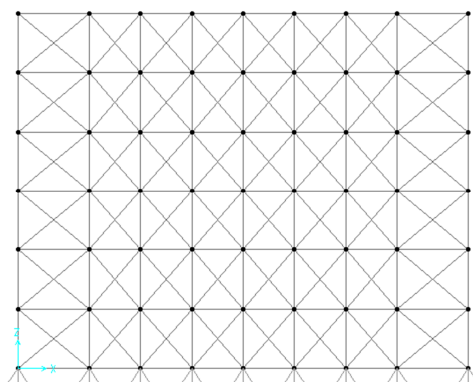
Contraventamento de Plano Vertical em que os Elementos de Contraventamento Estão Dispostos em Cruz
